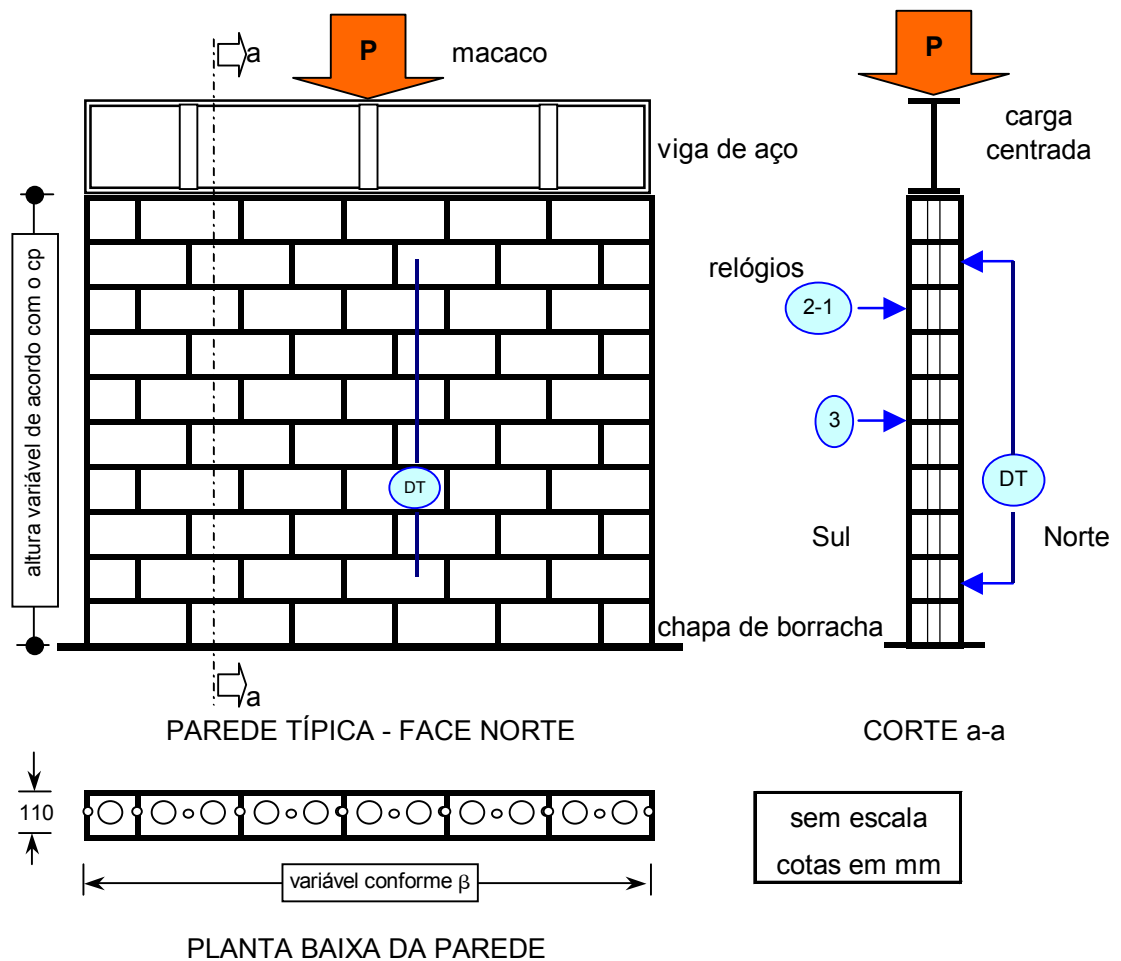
Parede típica – face norte, planta baixa e corte a-a
